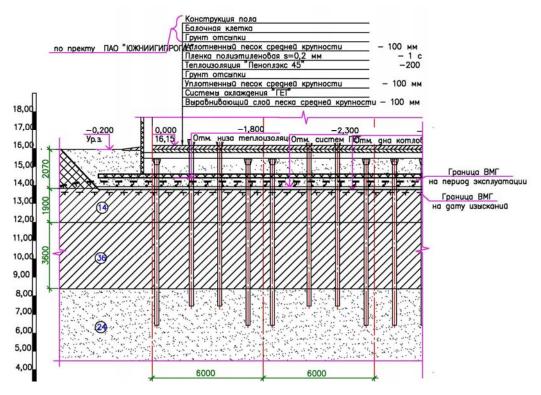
Здание на охлаждаемом основание системой ГЕТ с полами по грунту.
